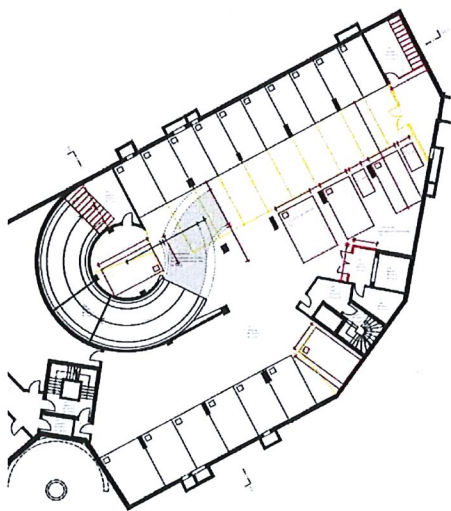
; Ausschnitt Grundriss 12. UG
